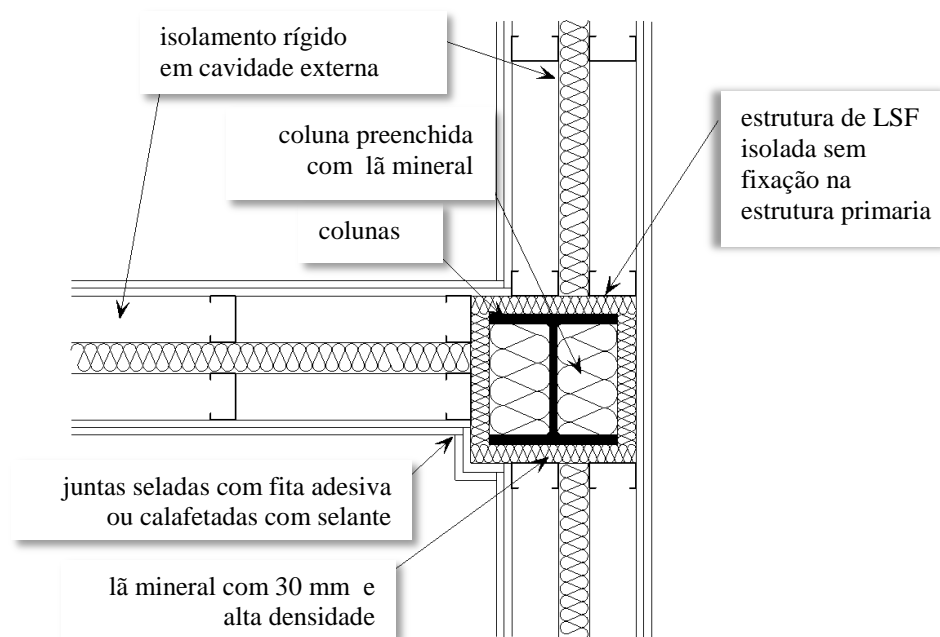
Planta esquemática que apresenta o isolamento dos pilares em relação as paredes de LSF. Fonte: Way e Couchman (2008).
